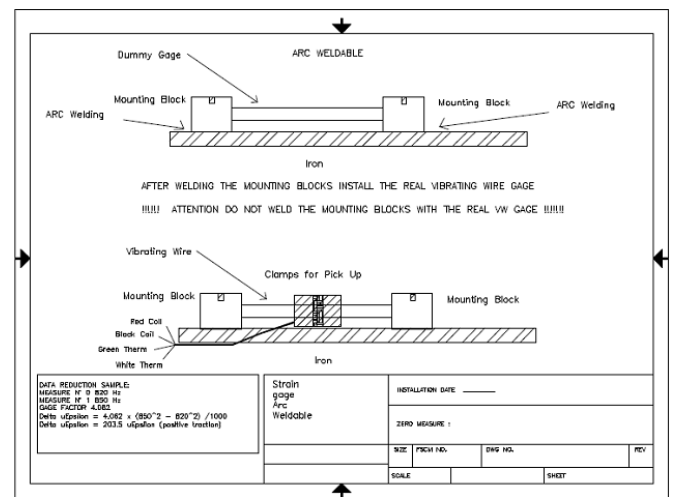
Estensimetro da saldare (Weldable type) – Schema installazione
